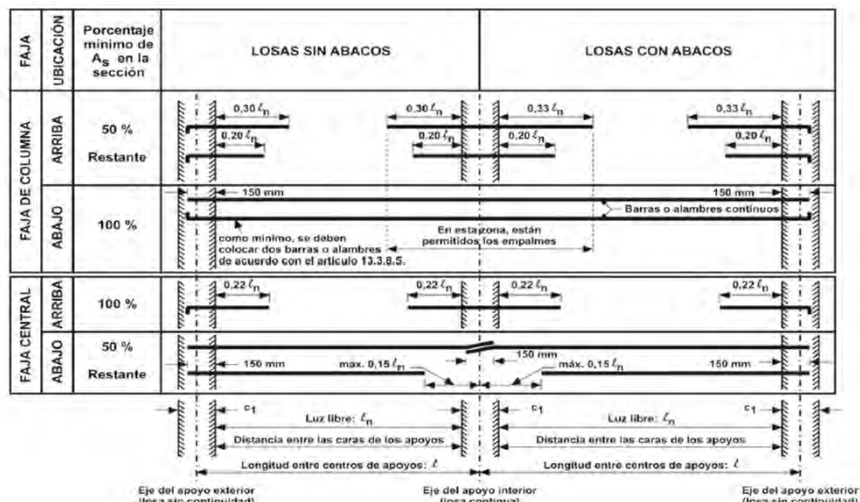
Prolongaciones mínimas para las armaduras en las losas sin vigas (ver el artículo 12.11.1. para la prolongación de las armaduras dentro de los apoyos).
